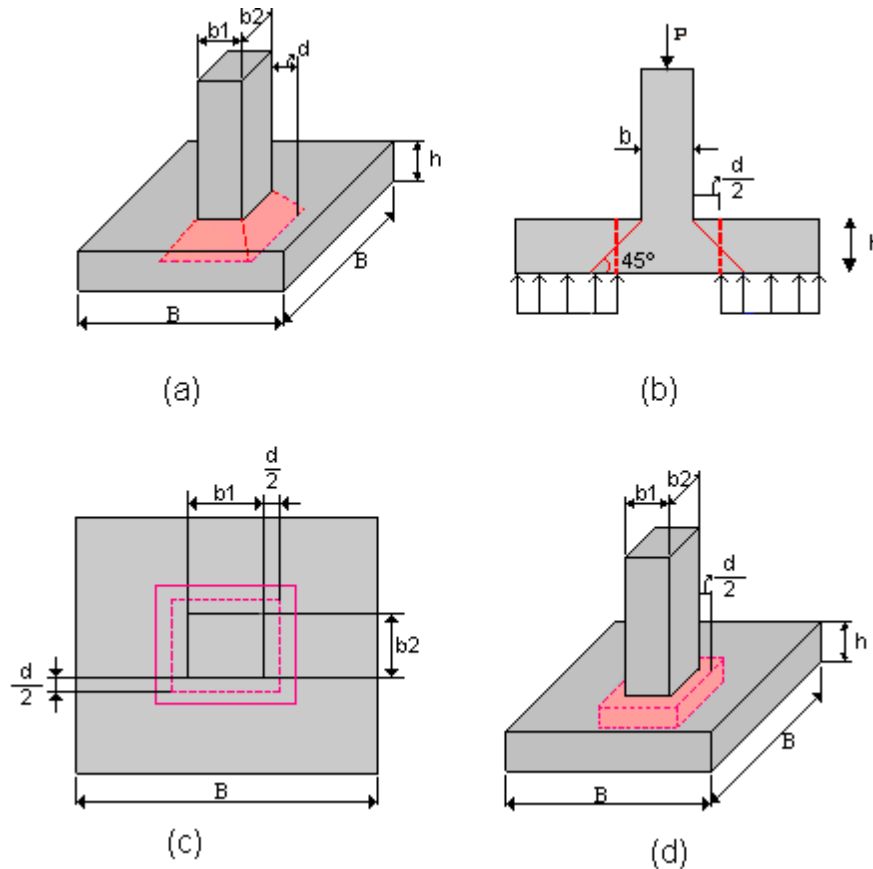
Cortante Bidireccional en Zapata que Soporta Columna, Pedestal o Muro de Concreto.
